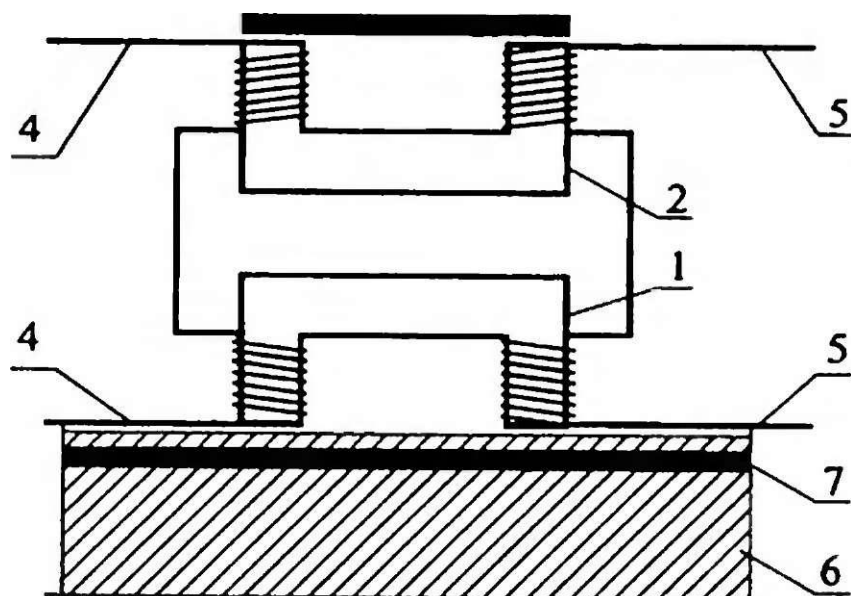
Индукционный прибор для проверки положения и диаметра арматуры и толщины защитного слоя: 1 - выносной индуктивный преобразователь; 2 - преобразователь в корпусе прибора; 3 - стержень для регулирования индуктивного сопротивления; 4 - проводка к источнику переменного тока; 5 - проводка к отсчетному устройству; 6 - железобетонный элемент; 7 - арматурный стержень
